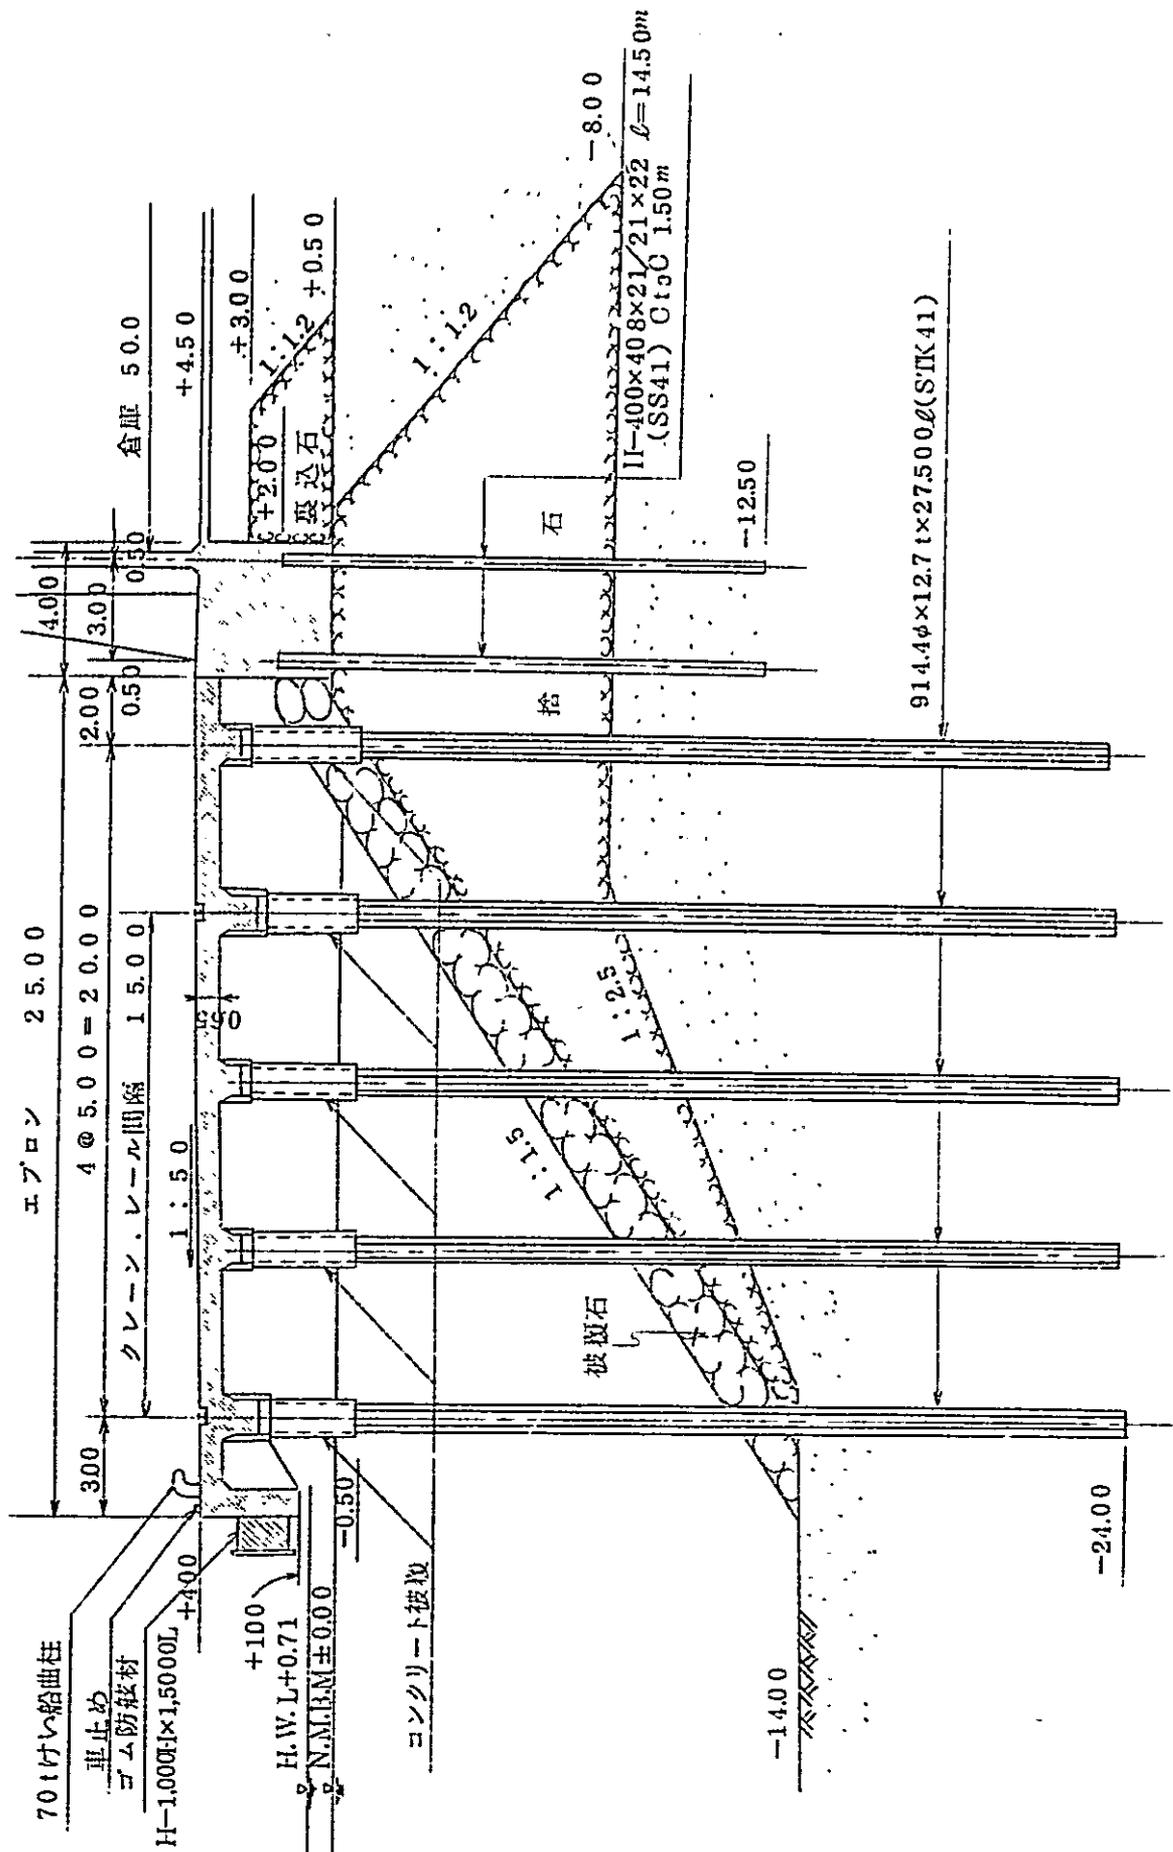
艀物用岸壁 デタッチトビヤ一構造標準断面図
